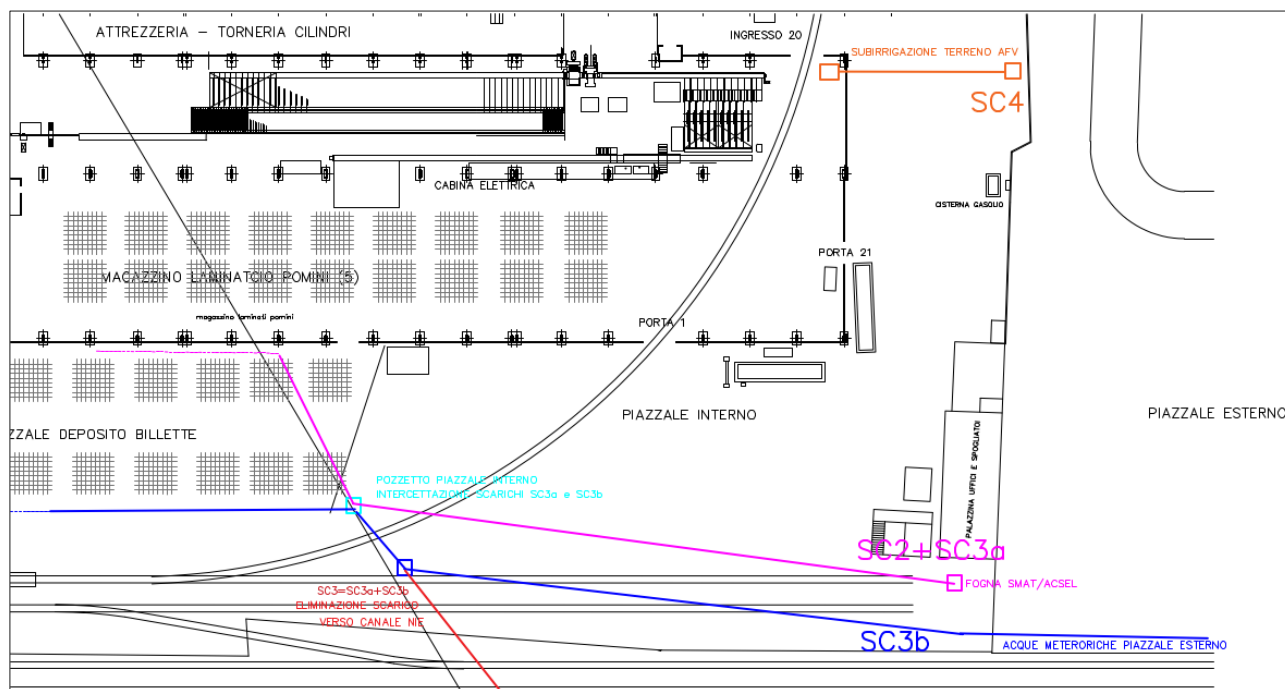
STRALCIO PLANIMETRICO DELL'ASSETTO ATTUALE DEGLI SCARICHI IDRICI
